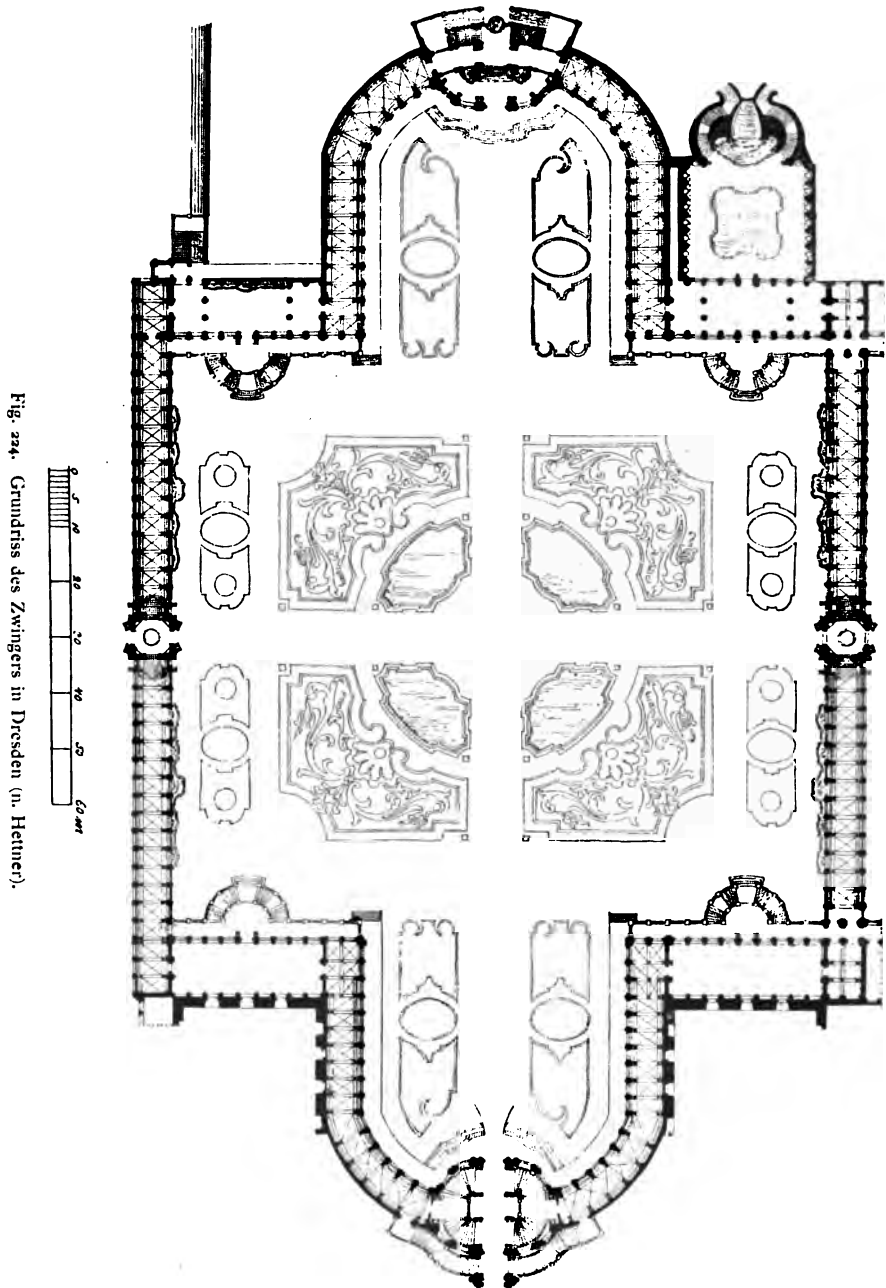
Grundriss des Zwingers in Dresden (n. Heiner).
